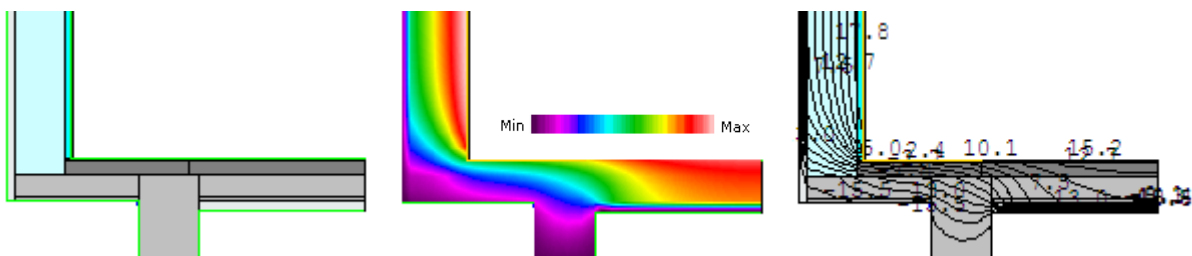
Detaliu vertical - îmbinare perete exterior cu planșeu din b. a., cota +3.59 m – tip 2
